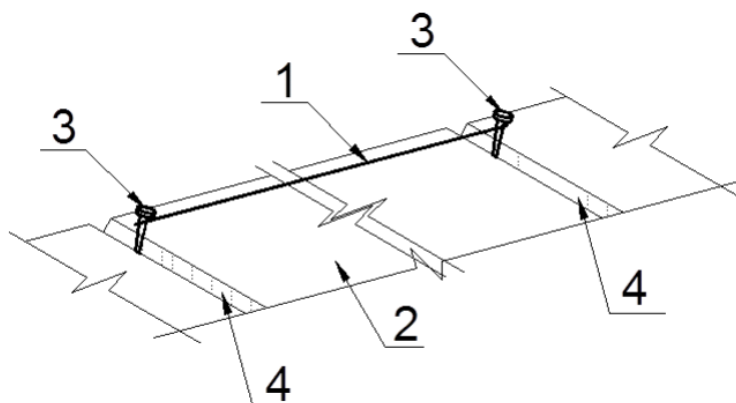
Влаштування причального шнура. 1 – причальний шнур; 2 – плита перекриття; 3 – цвяхи; 4 – шов між плитами перекриттів
